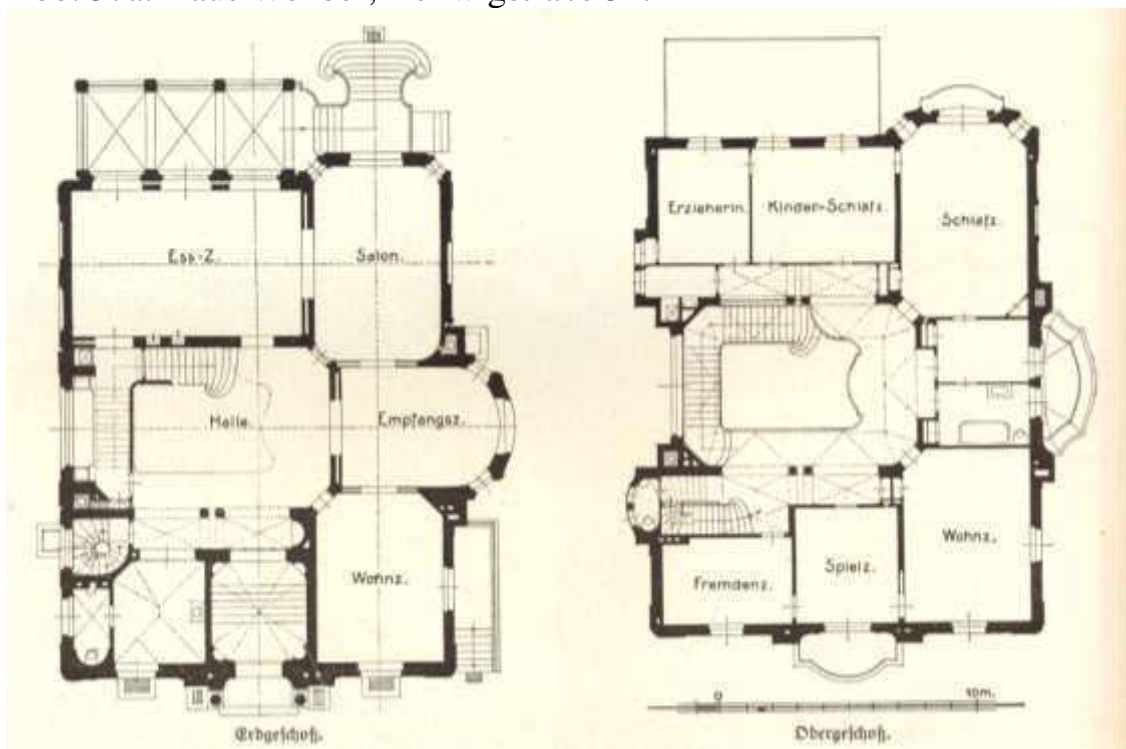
Haus Wehber, Grundrisse.
